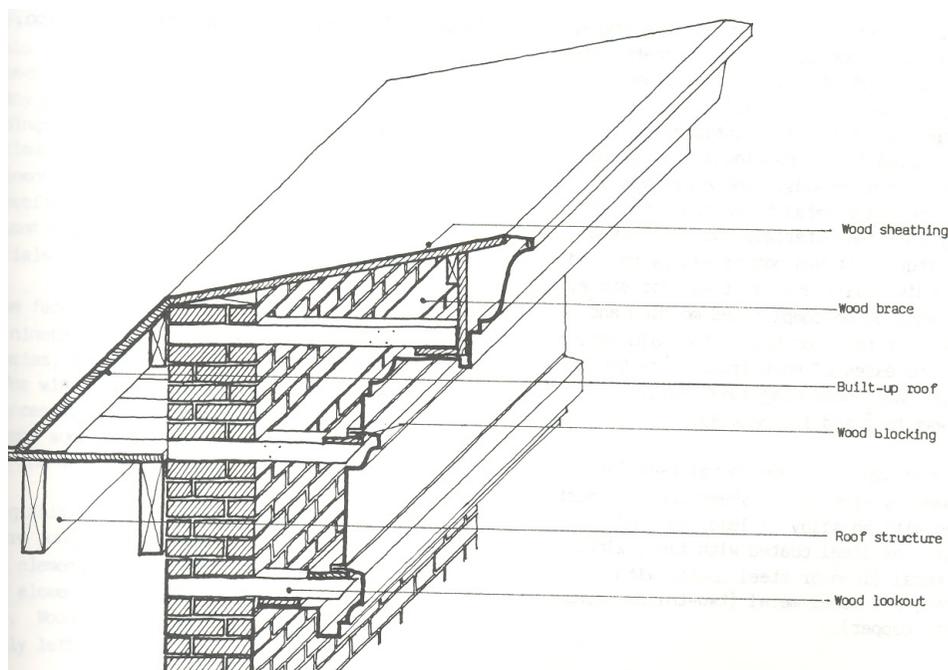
Detalle constructivo de la coronación de una fachada con chapa metálica. Fuente: *Historic Building Façades: The Manual for Maintenance and Rehabilitation*, 1997
